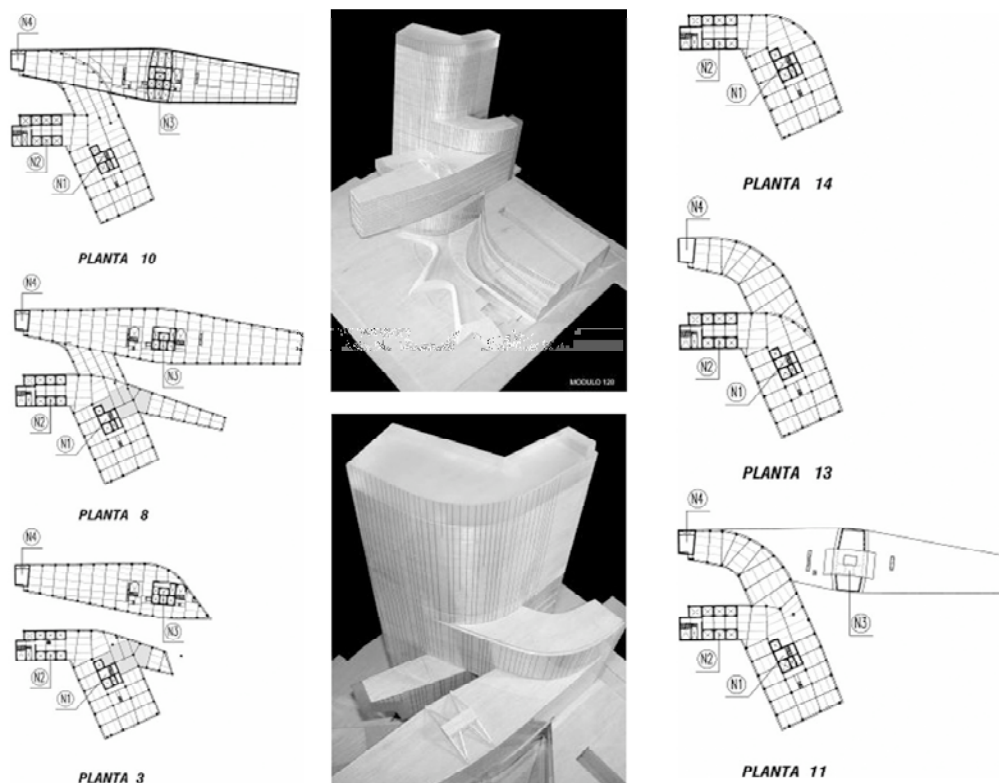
Secuencia de algunas plantas y fotos de la maqueta arquitectónica.
